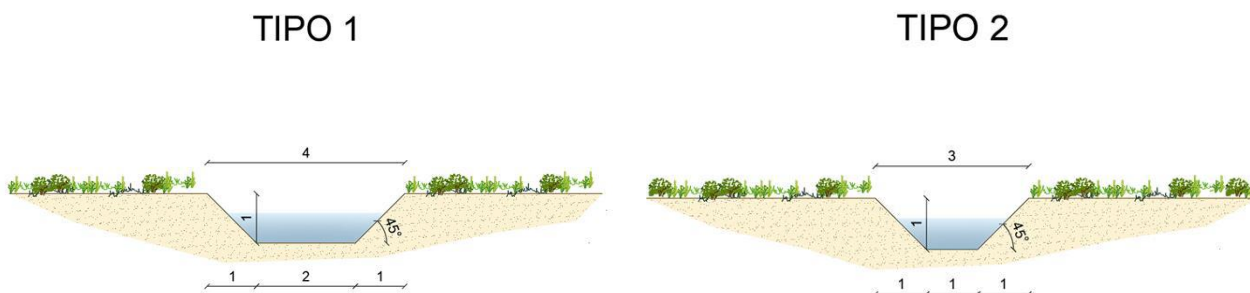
Sezione trasversale dei canali in progetto "Tipo 1" e "Tipo 2"
